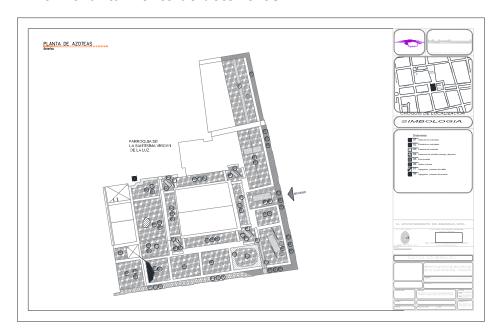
Planta de azoteas deterioros. Eloísa Galván González 2014.
